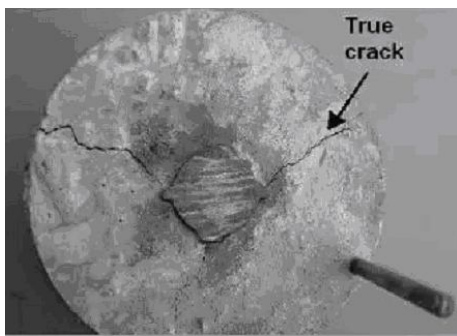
Картина розтріскування циліндричного зразка (з публікації [14]) / Pattern of cracks cylindrical sample [14]
